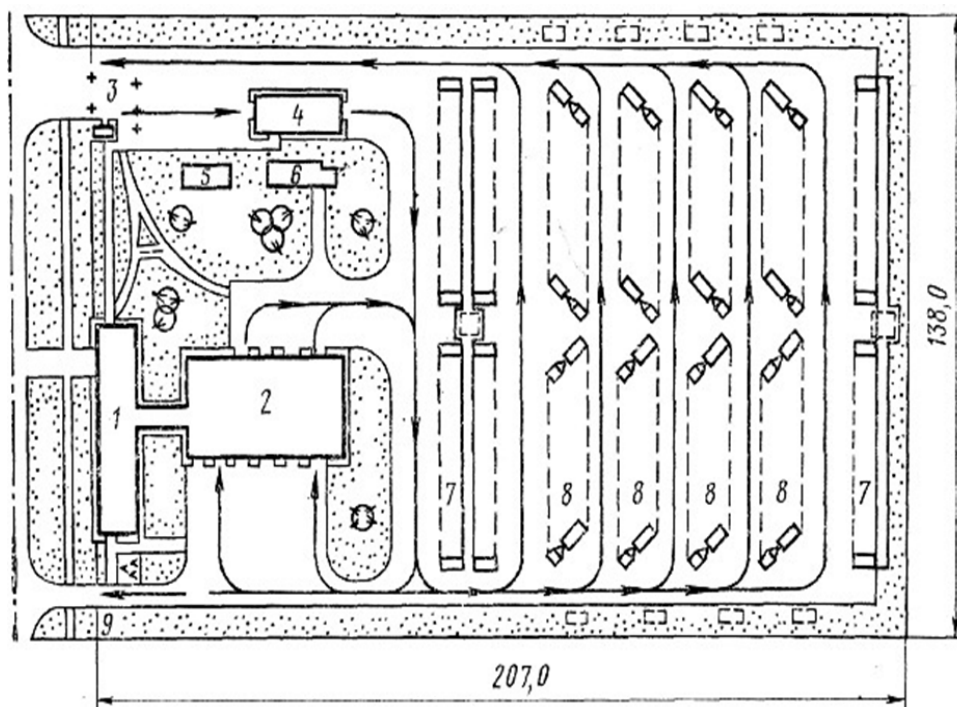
Схема генерального плану ПАТ на 200 вантажних автомобілів:
